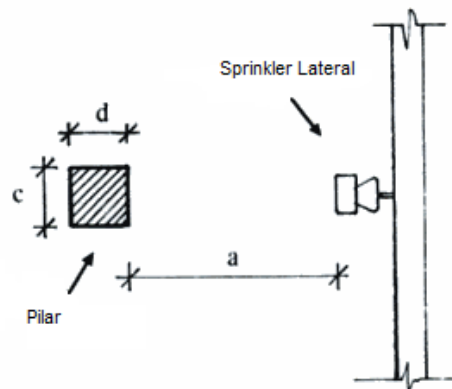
Afastamento entre sprinkler lateral e pilar
